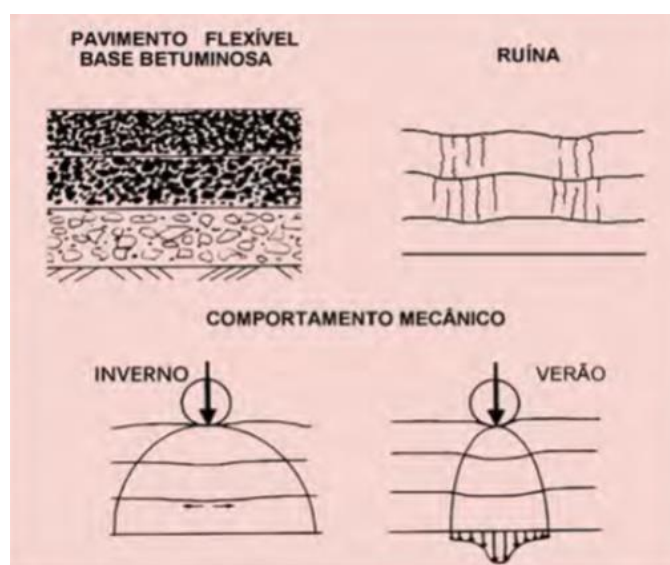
Comportamento Pavimento Flexível – Base Betuminosa
